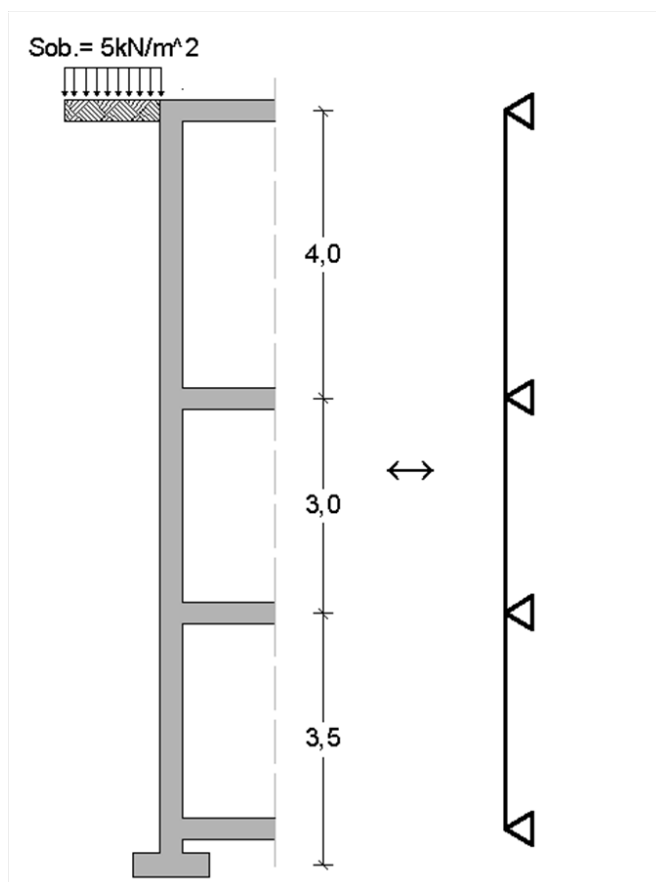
Esquema Estrutural do Muro de Suporte 1 (MS1).
